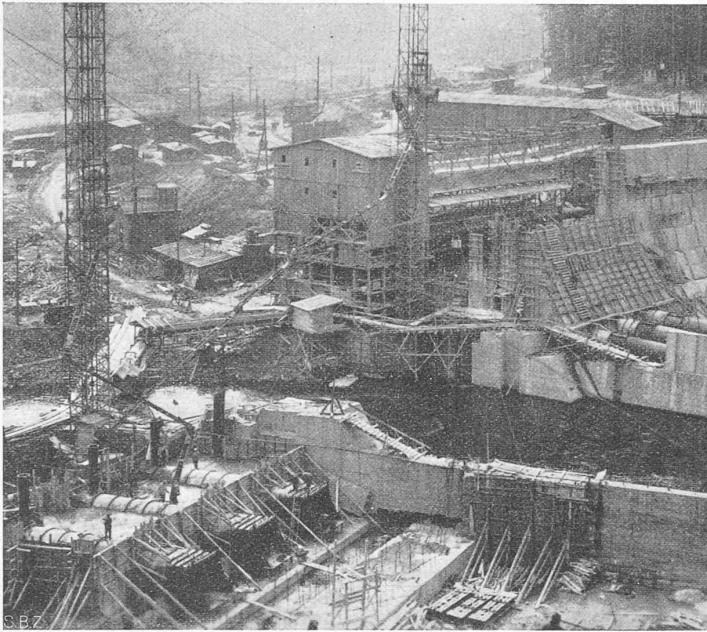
Grundablässe, umgeleitete Zschopau und Druckleitungen. Betonwerk mit Giesstürmen 1 und 2.
